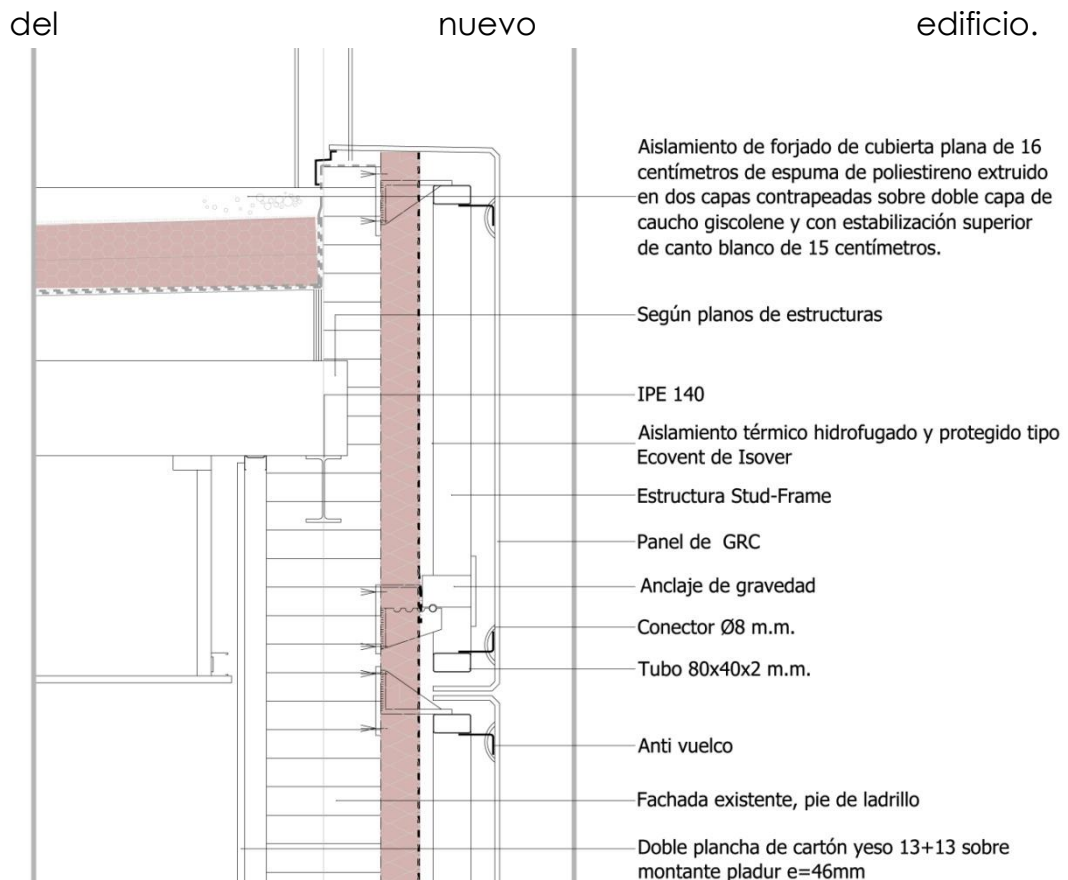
Detalle constructivo de la fachada opaca, con el aislante resaltado. Fuente: Alia arquitectos.
